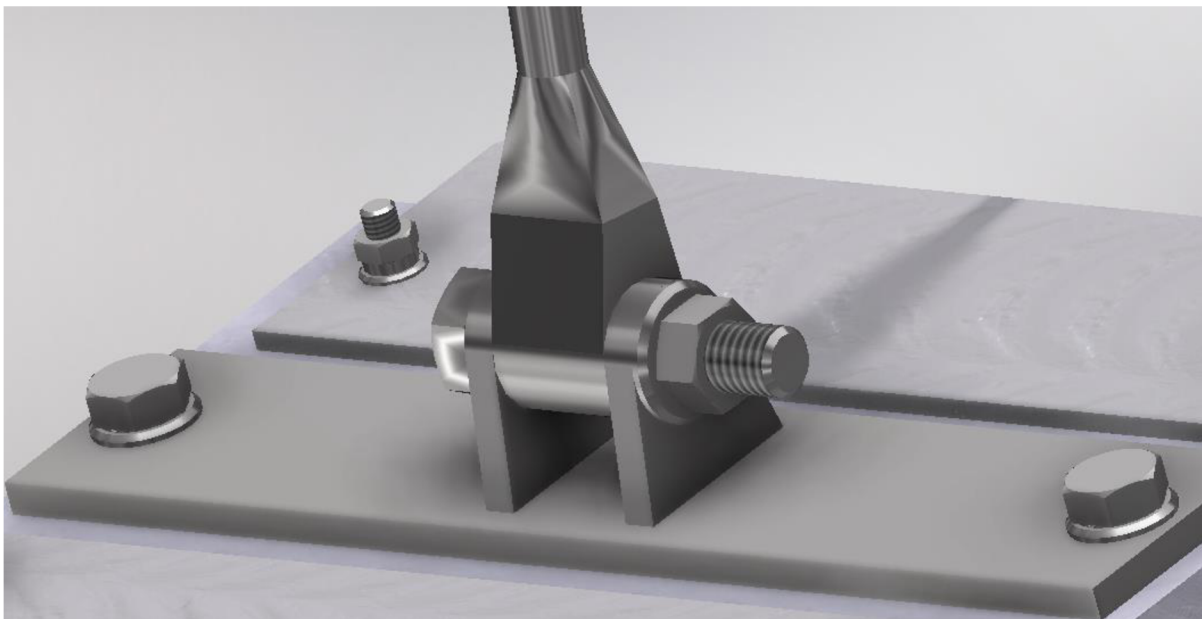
Detail utahovacího elementu s axiálním ložiskem
